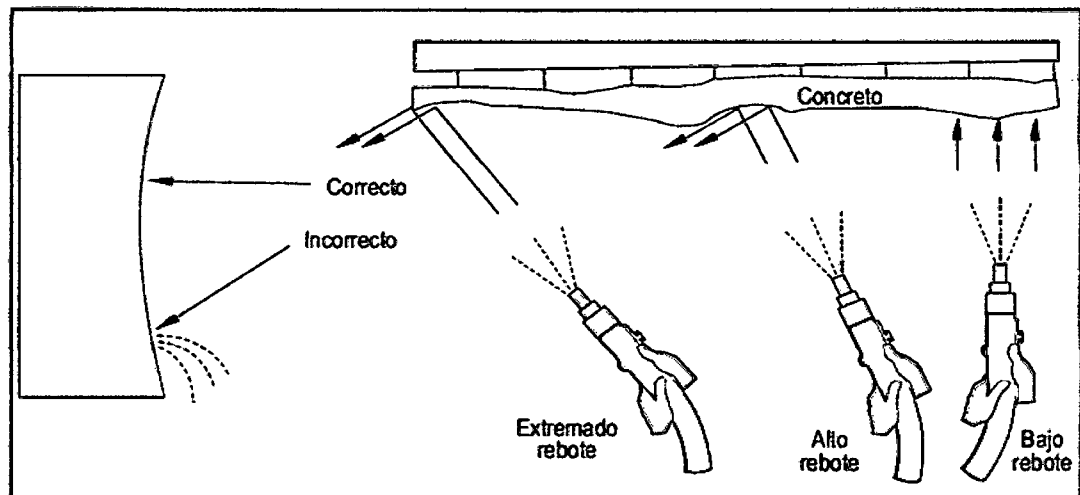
Posición de la boquilla a la hora de lanzado shotcrete (in. Consorcio Minero Horizonte)
